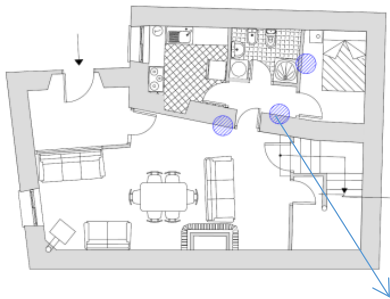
Humedad en la pared del pasillo de planta baja. 2017. Fuente: Autor.
